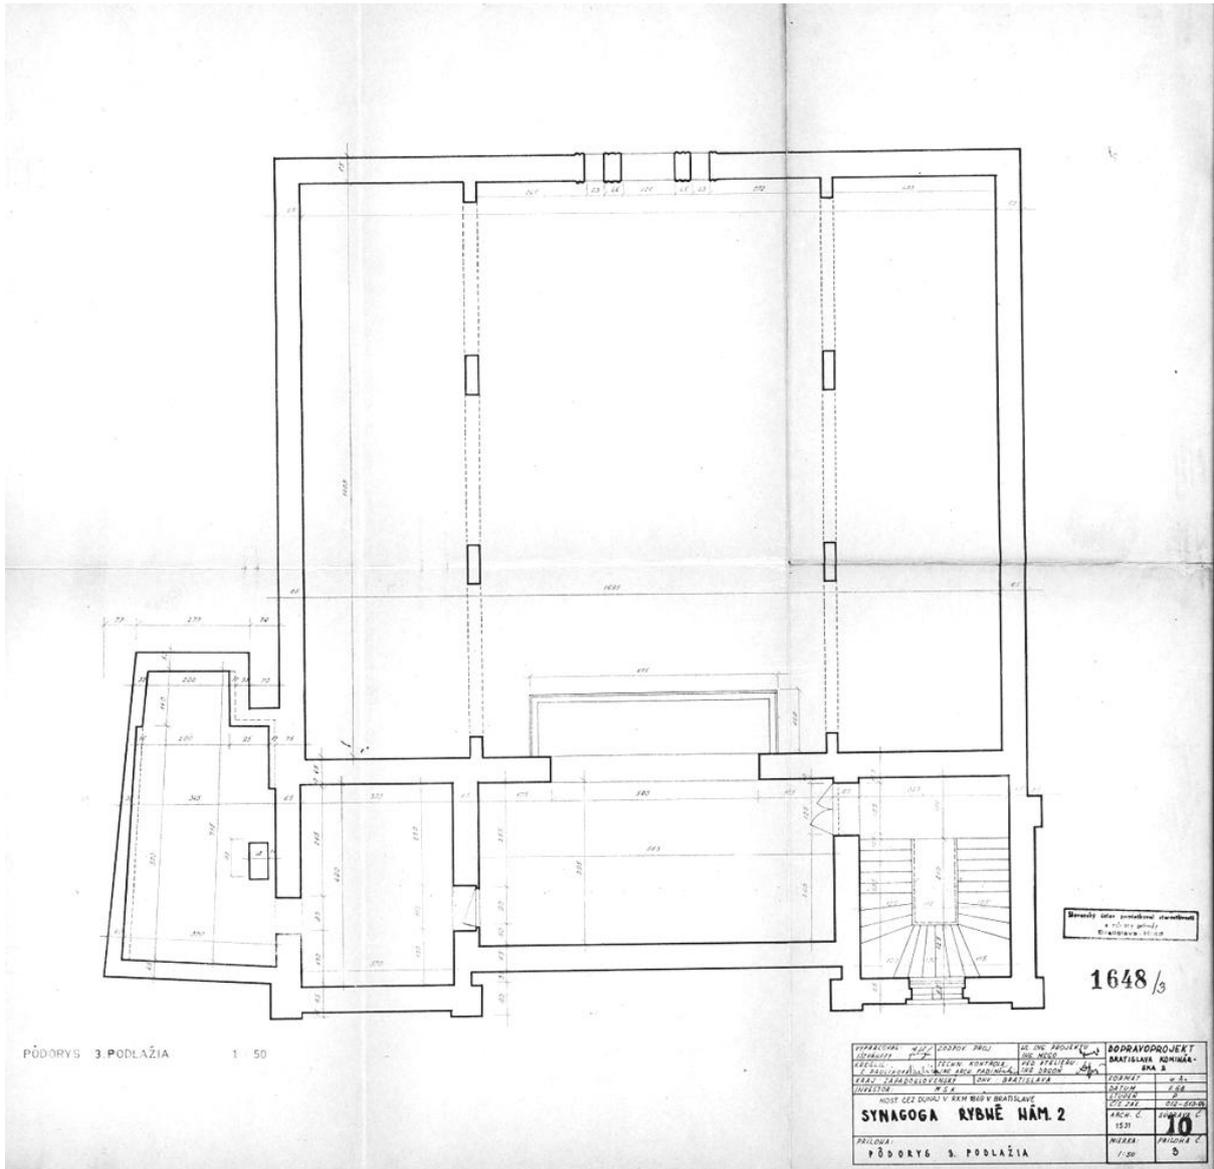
Grundriss 2. Obergeschoss M 1:50, 1967
